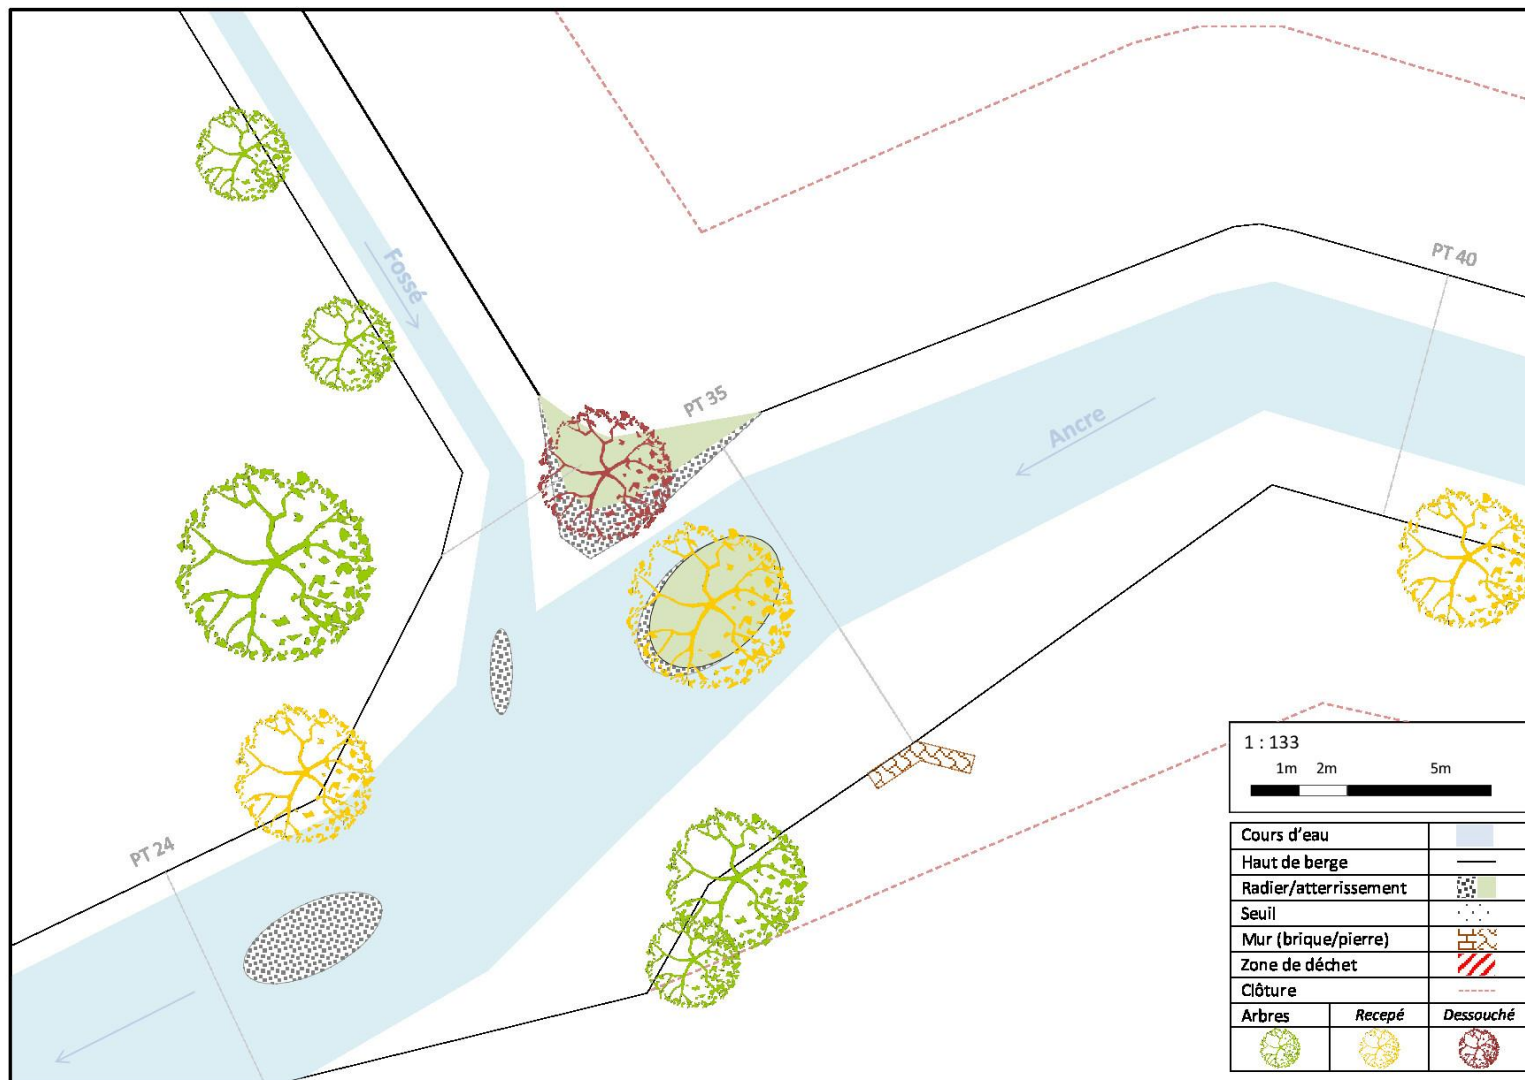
Plan de masse du projet au droit du seuil de l'ancien moulin Troussel
